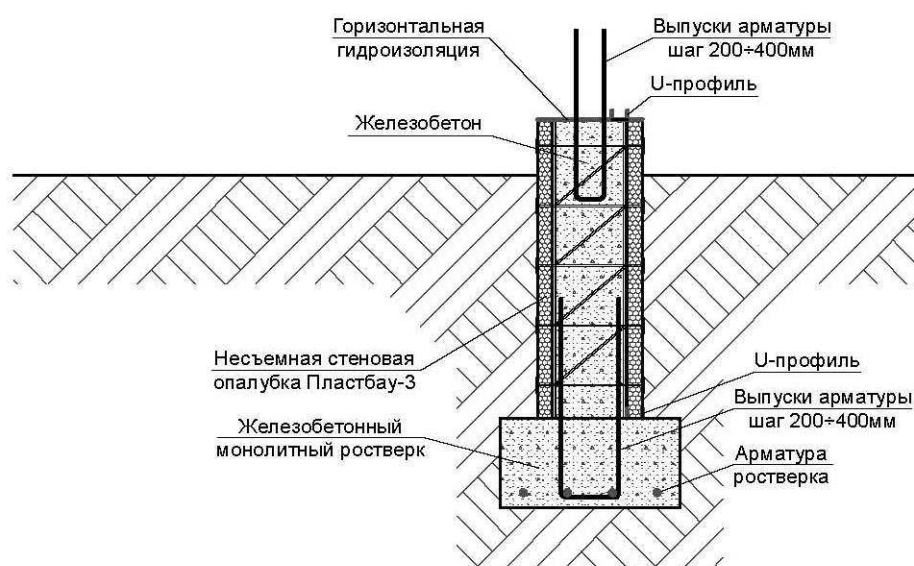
Конструкция фундамента с использованием стеновых элементов системы Plastbau-3.
